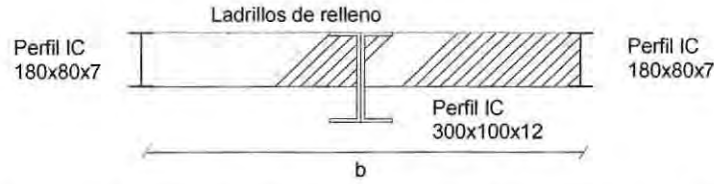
Corte 1-1 plano de elevación Figura 1.12, configuración 1° piso.
